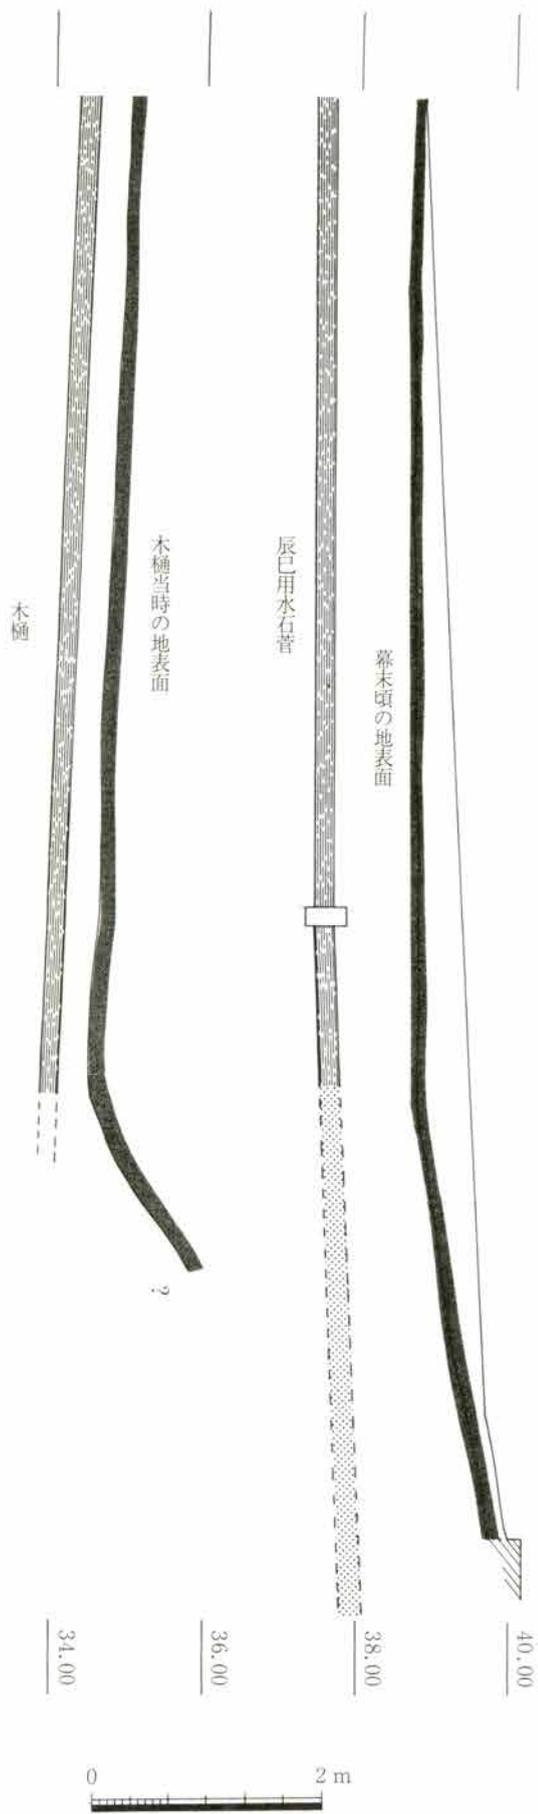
木樋と辰巳用水石管平・断面図 (1/400、断面図の高さのみ1/100)
